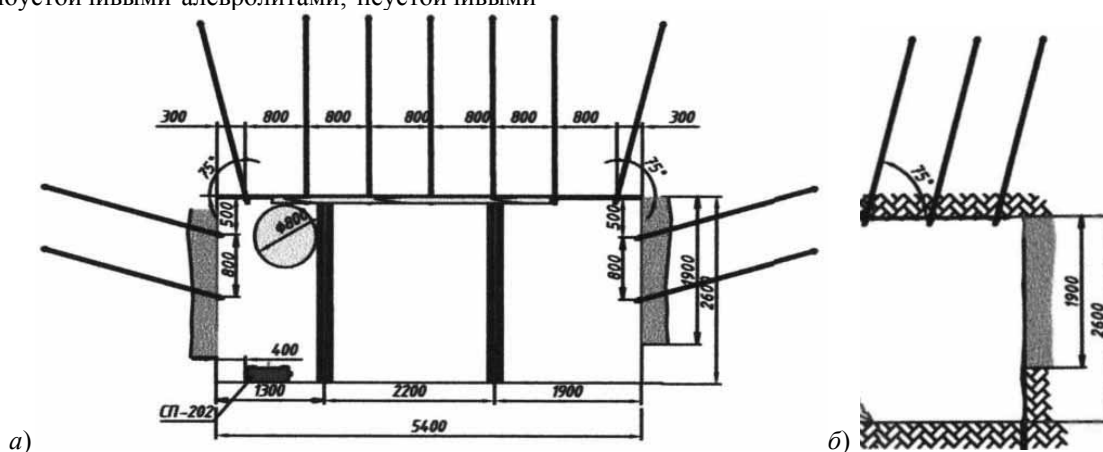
Схема установки анкерной крепи: а) поперечное сечение; б) продольное
